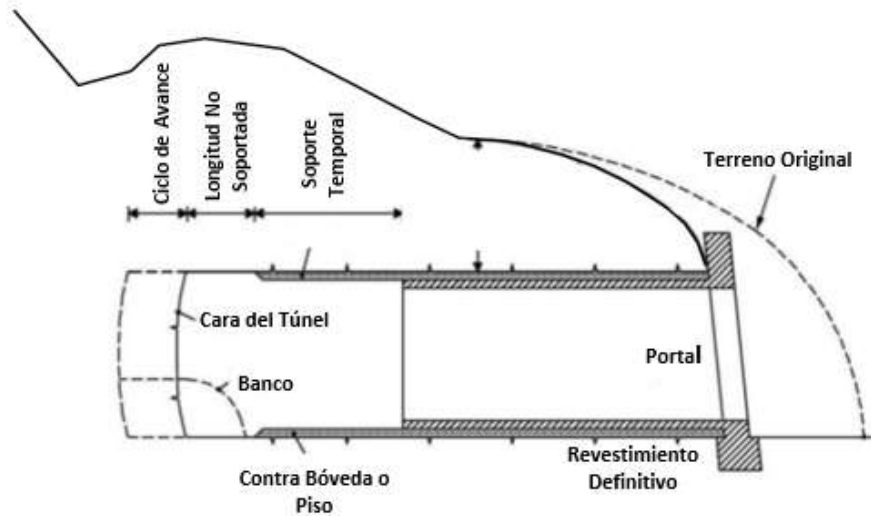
Nomenclatura utilizada en el diseño y construcción de túneles – Sección Longitudinal
